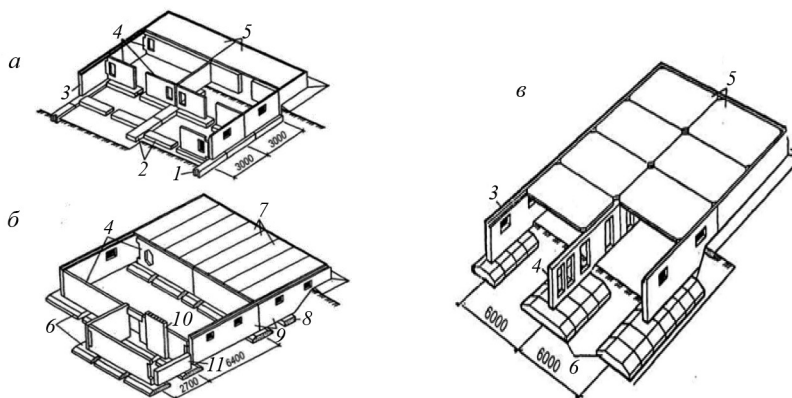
Підземна частина великопанельних безкаркасних будівель:
